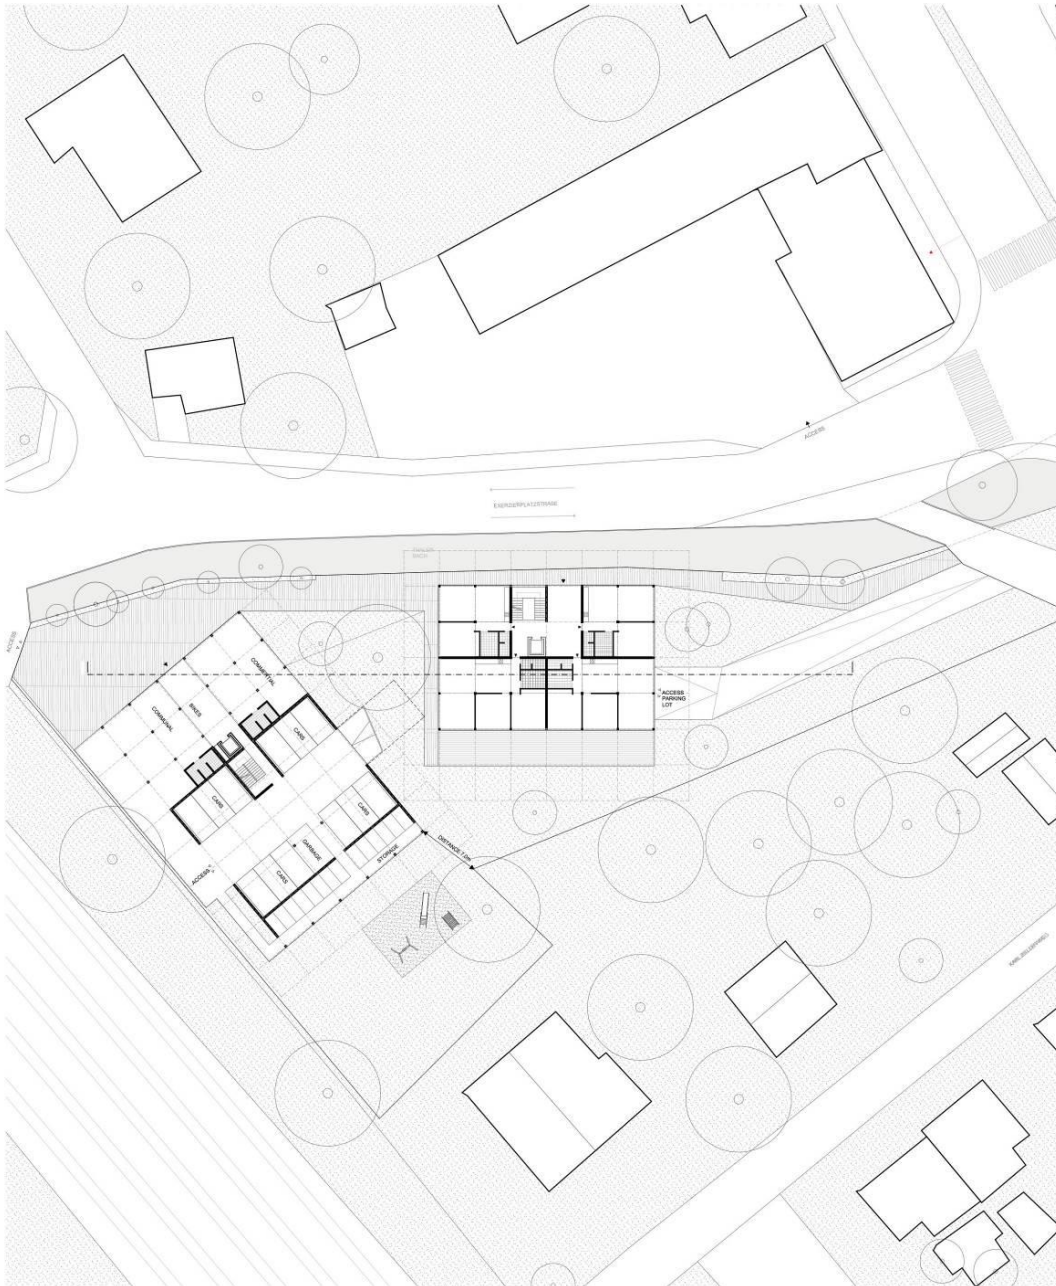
Lageplan mit Erdgeschoß Entwurf *Fitting In
